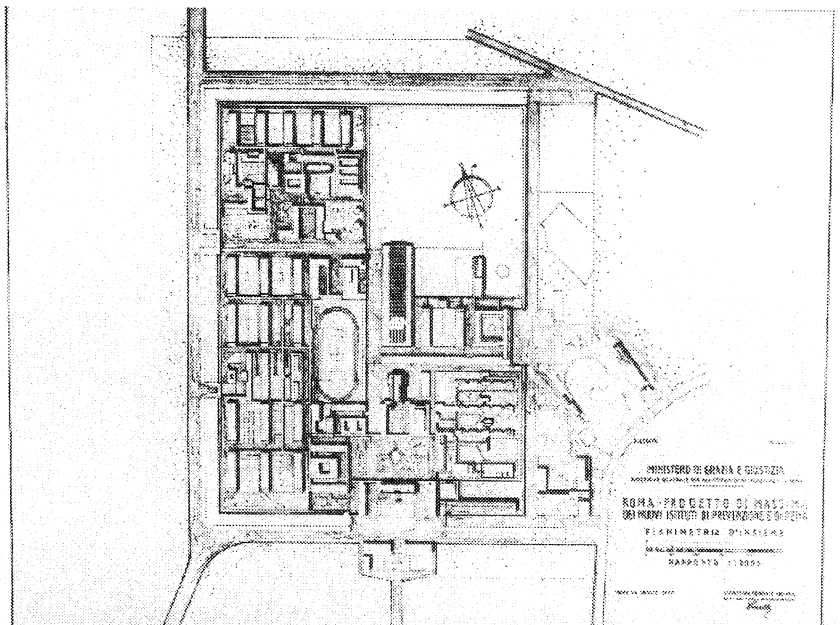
Ing. Carlo Vittorio Varetti - Progetto di massima
